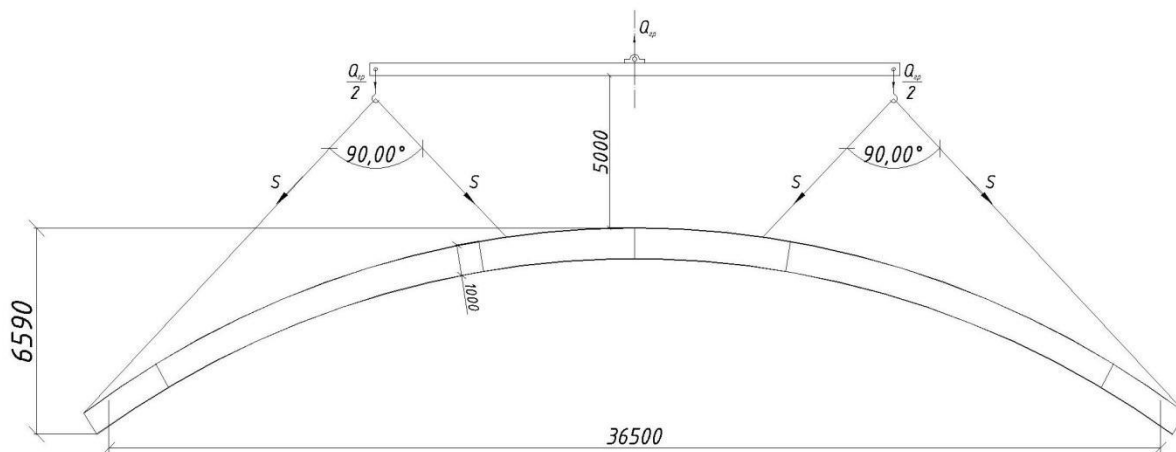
Розрахункова схема строповки гнучкими канатами
